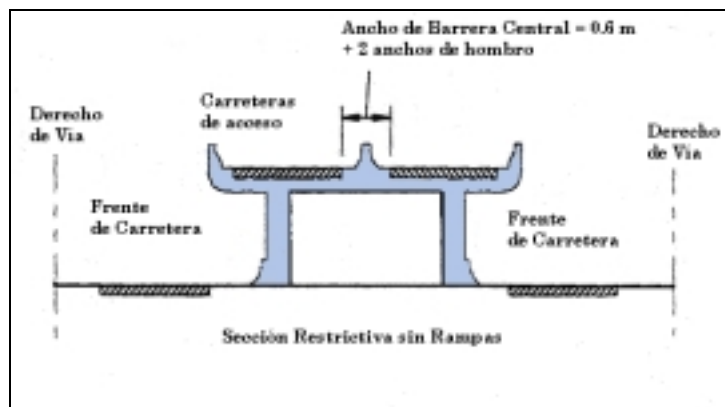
Sección transversal de autopistas elevadas (AASHTO Fig. VIII-9), [De *A Policy on Geometric Design of Highways and Streets*.]
